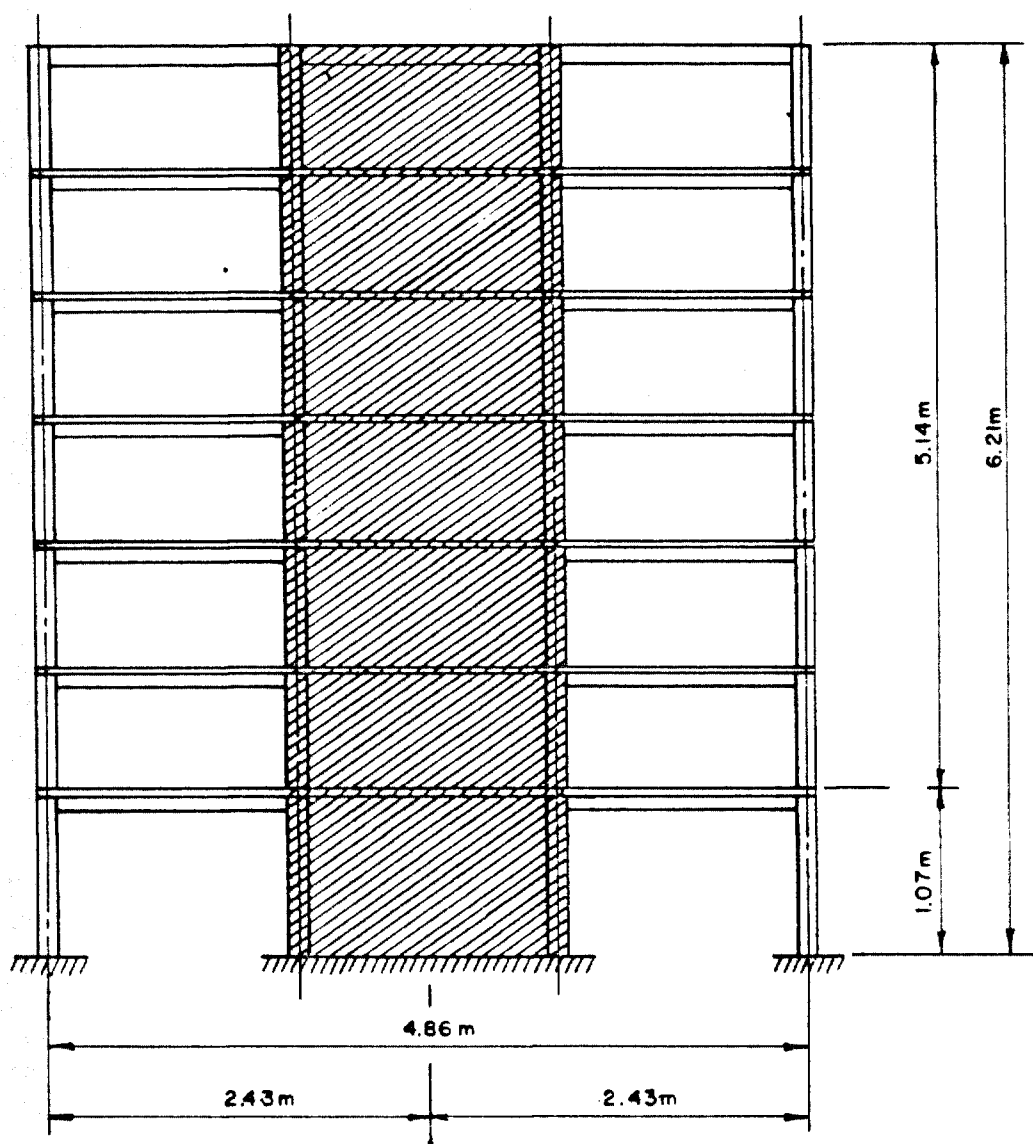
Modelo misto parede-pórtico testado
